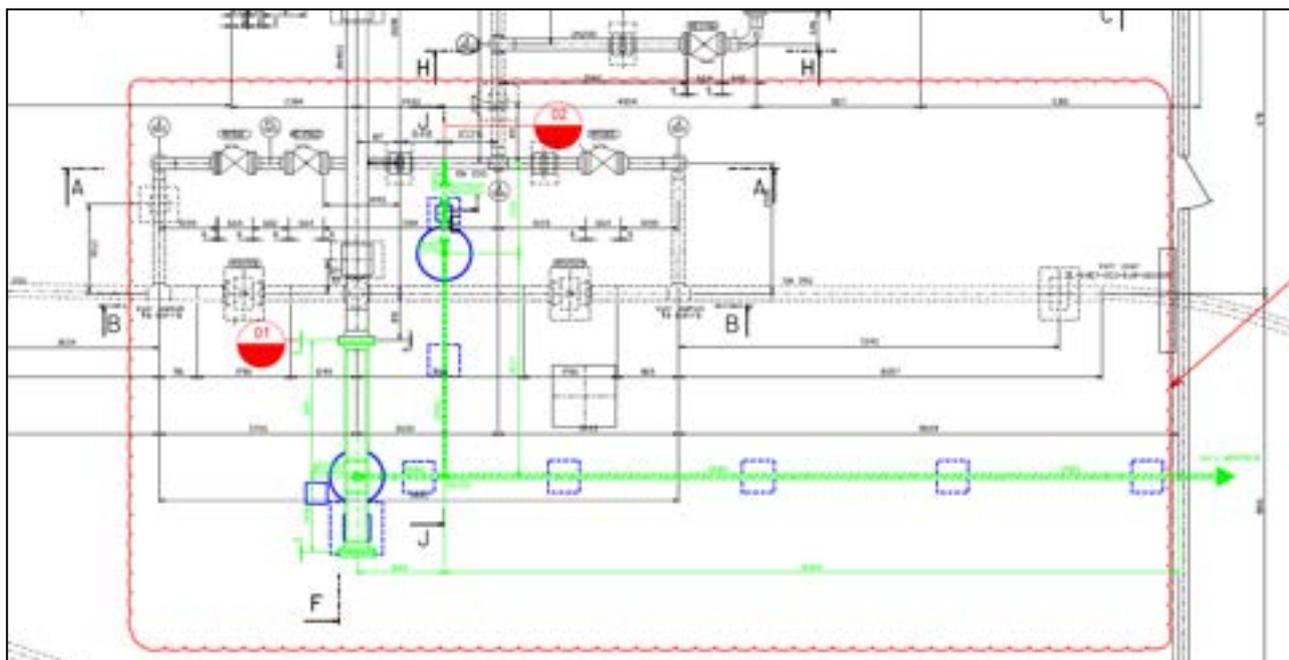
Modification du Poste de Sectionnement de Bressols (en noir les installations existantes, en vert les installations projetées)
